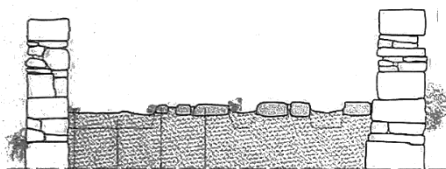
Ilustración de la restauración de una zona pavimentada. Fuente: (Vegas & Mileto, 2011)
